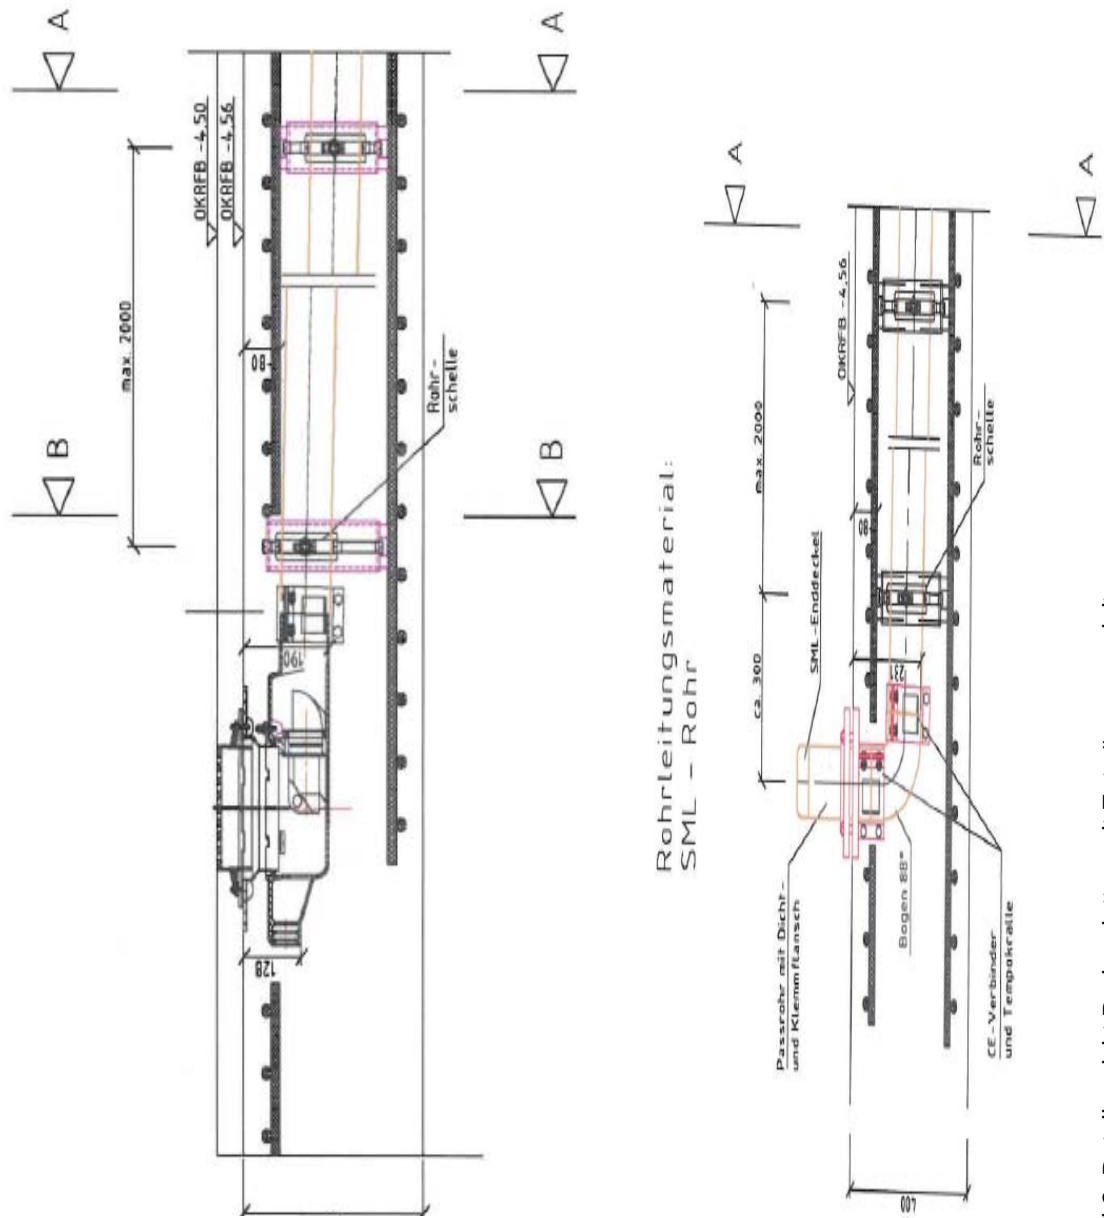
Detailsicht Bodenplatten mit Entwässerungsleitungen
